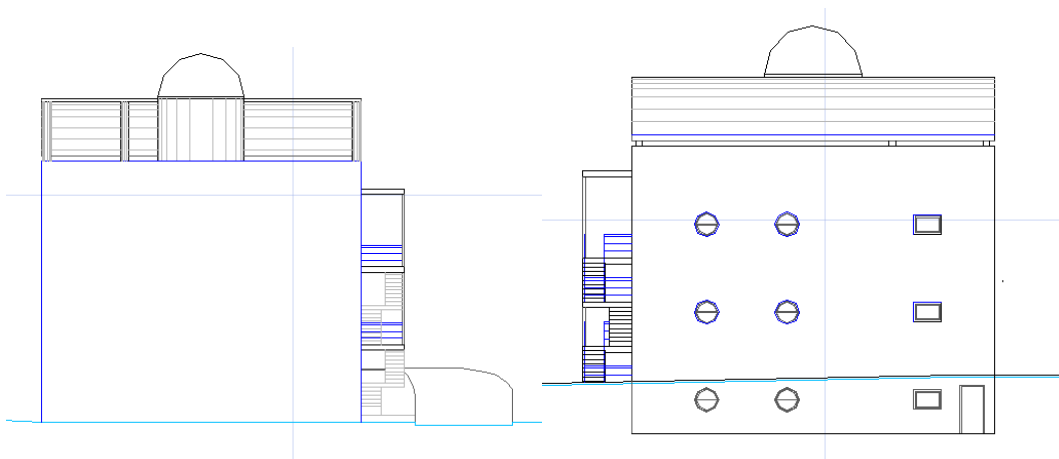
Fachada Oeste e fachada Este, respetivamente.
